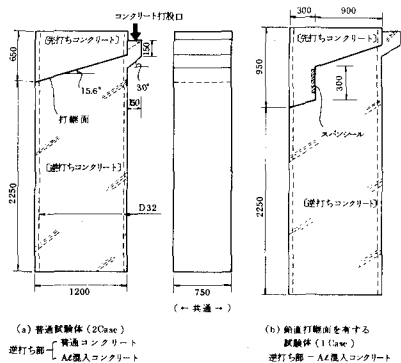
逆打ちコンクリート試験体の形状、寸法及び打継面の透水試験方法
